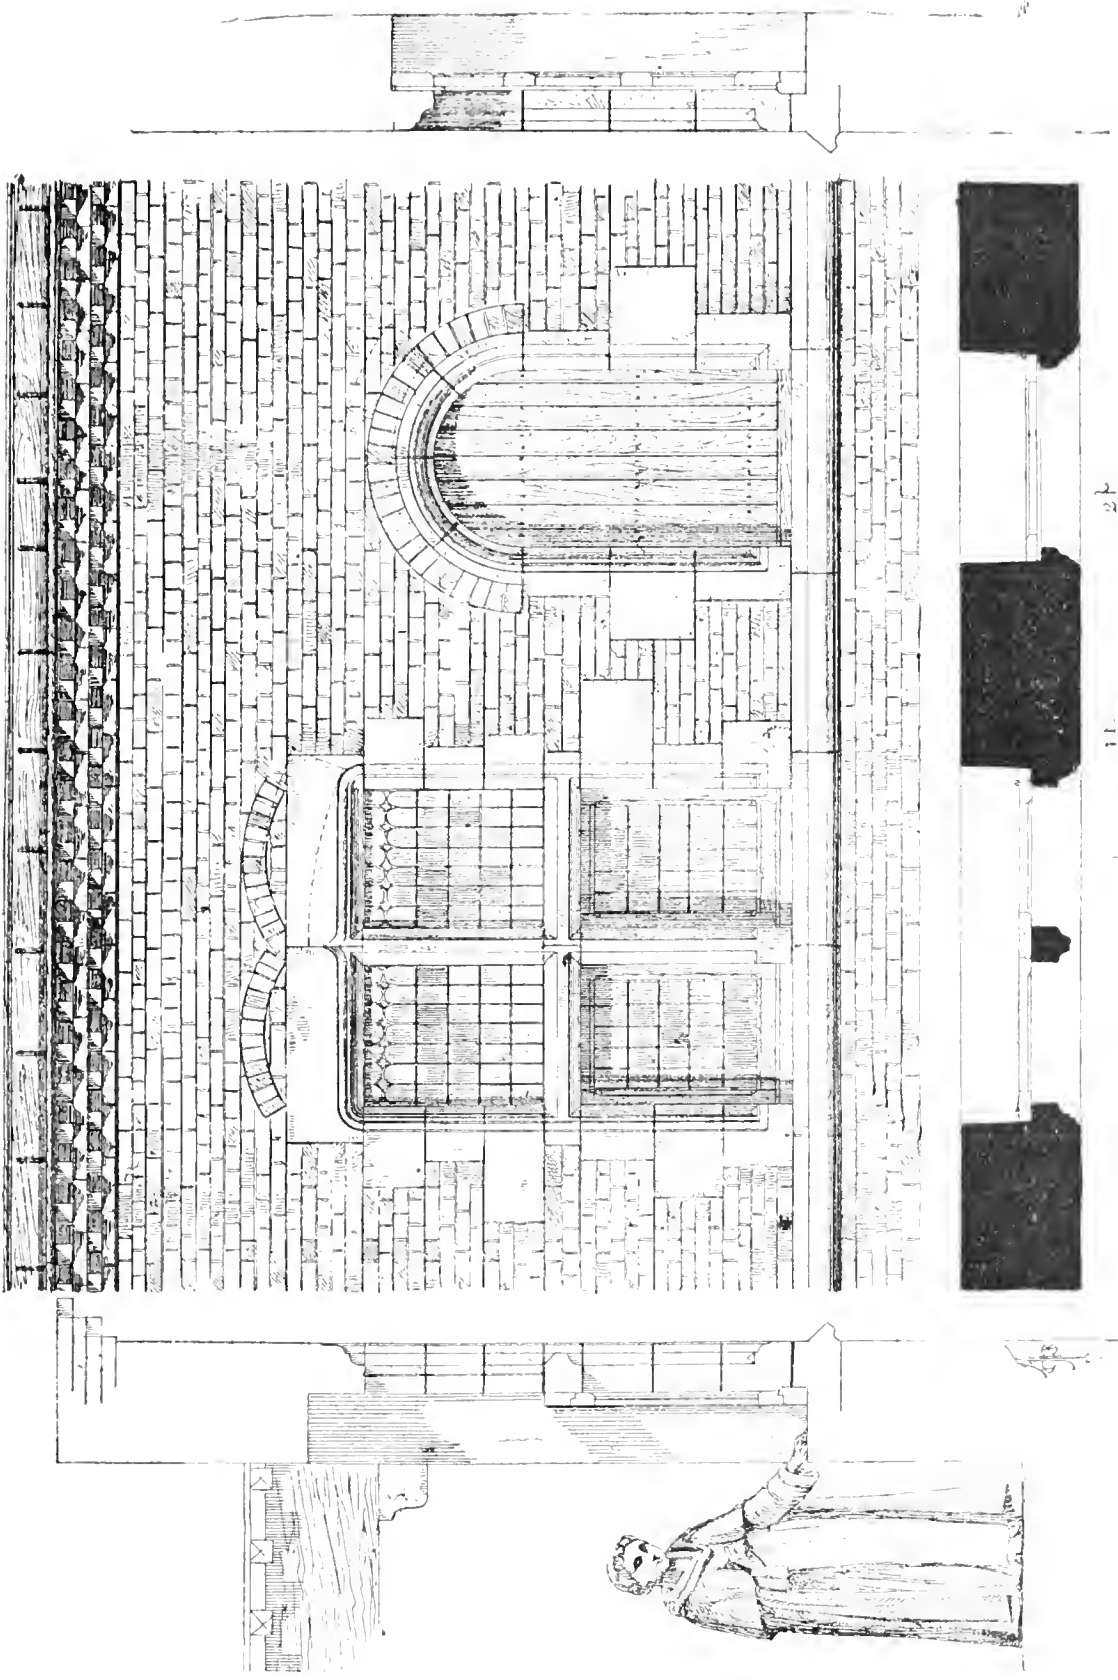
Fenêtres à la façade de la Brasserie vers la cour. Détails.
